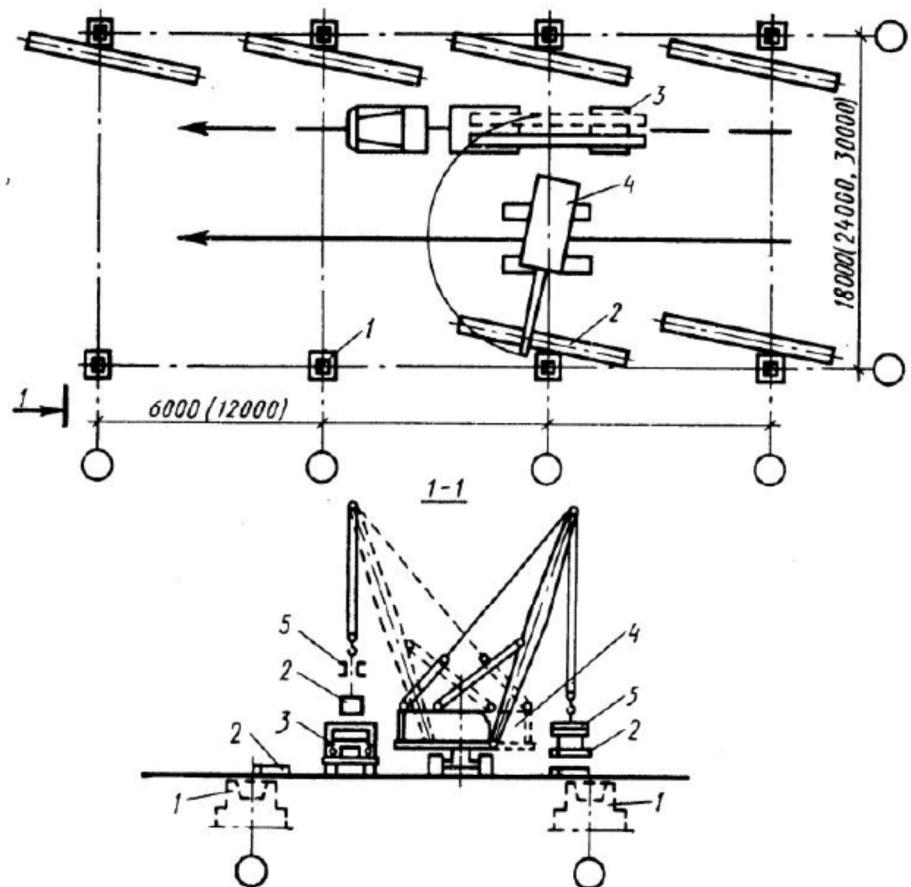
Схема выгрузки и предварительной раскладки колонн в зданиях пролетом 18, 24 и 30 м: 1 - стакан фундамента; 2 - колонна; 3 -транспортное средство; 4 - кран; 5 - траверса.
